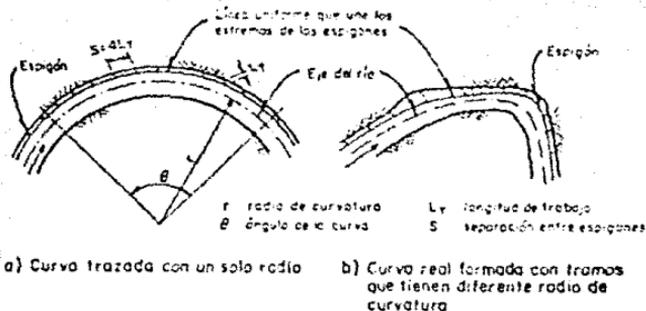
LOCALIZACIÓN EN PLANTA DE UNA OBRA DE PROTECCIÓN CON ESPIGONES (Ref. 11)
